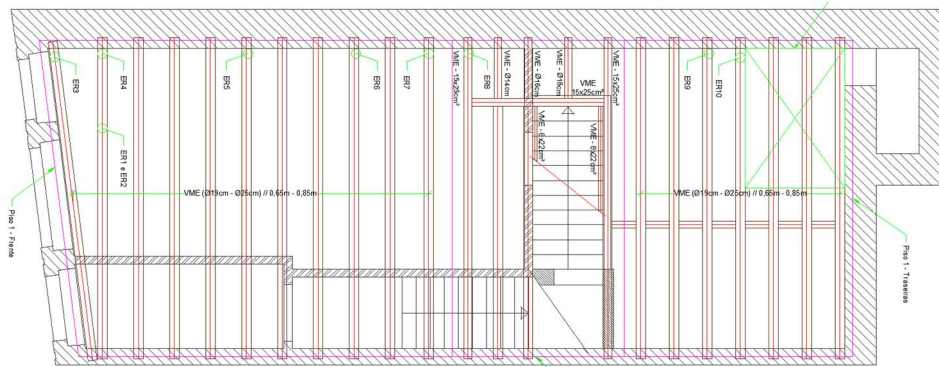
Projeto estrutural do piso 1 (Edifício 4)
